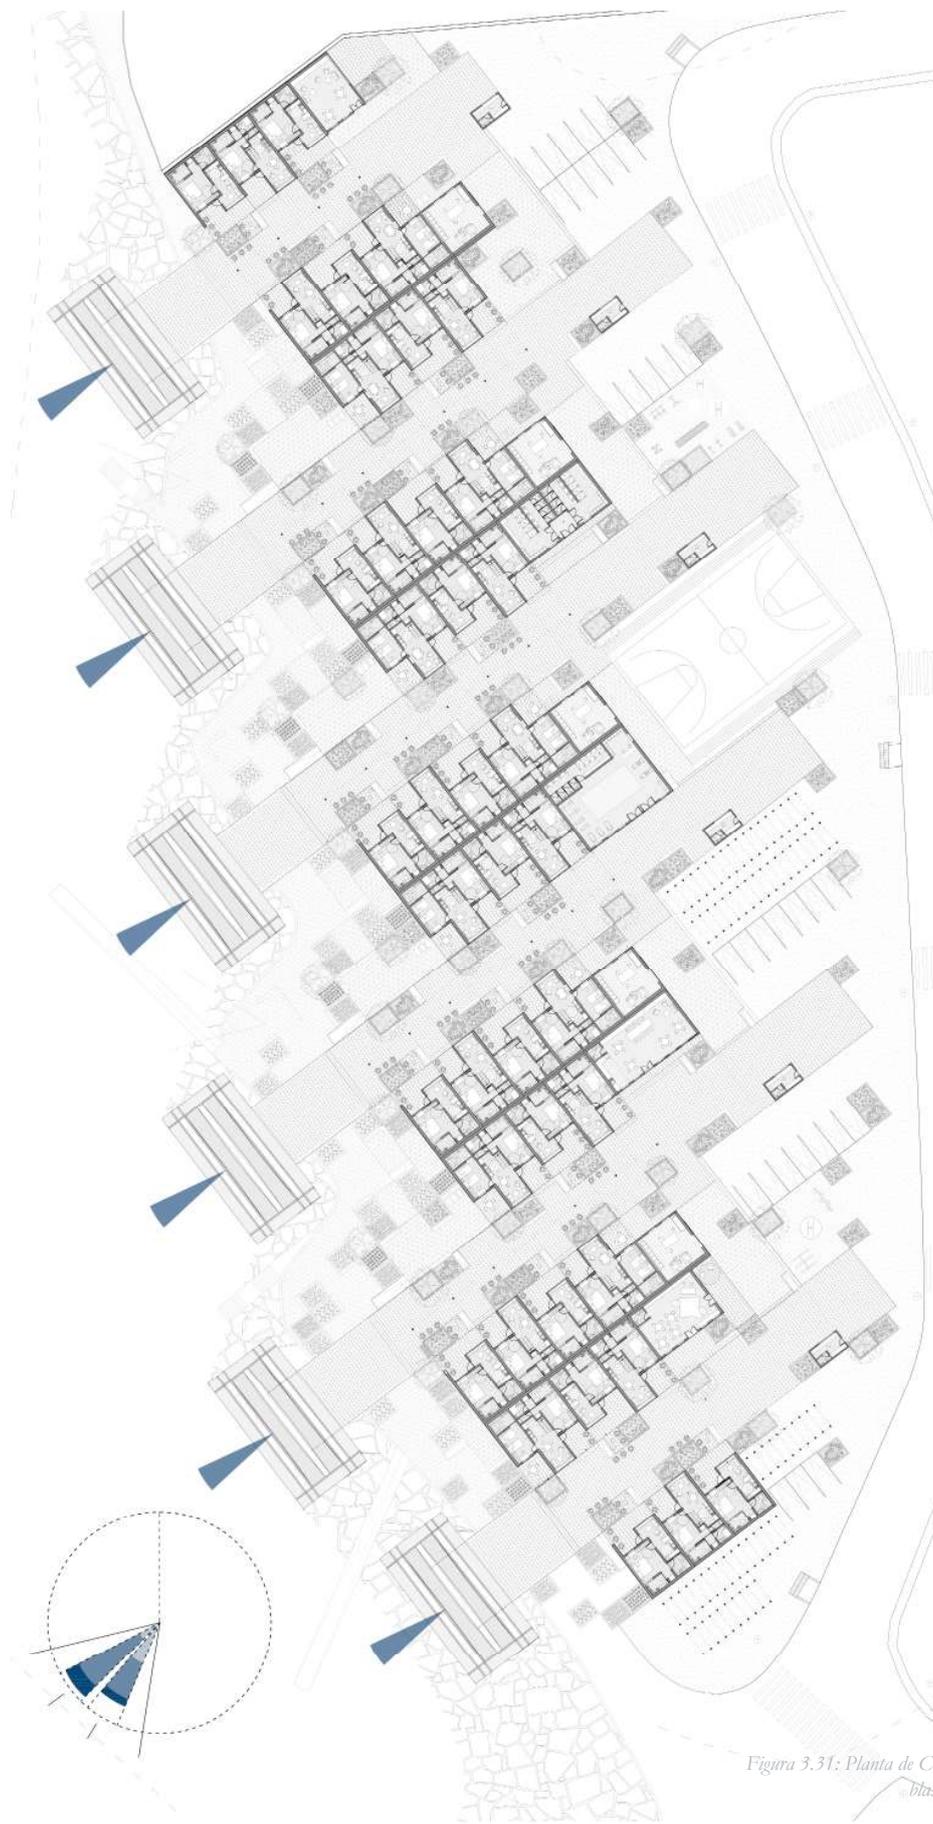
Planta de Conjunto Condominio Atrapanieblas, sector el Boror, Alto Hospicio.
